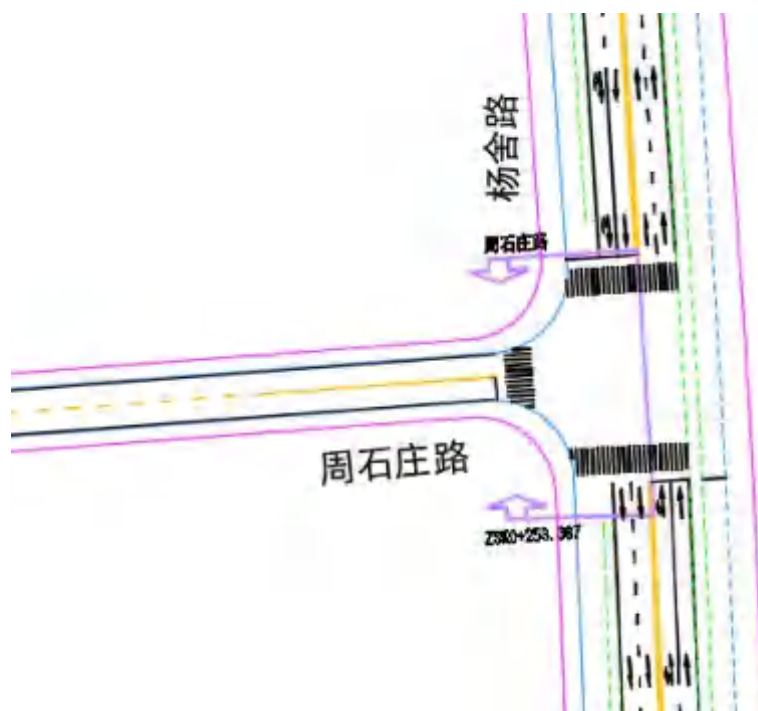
周石庄路-杨舍路交叉口平面布置图
